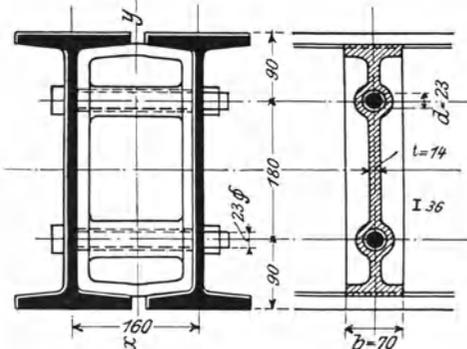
Querverbindung durch gußeiserne Kupplungen.
